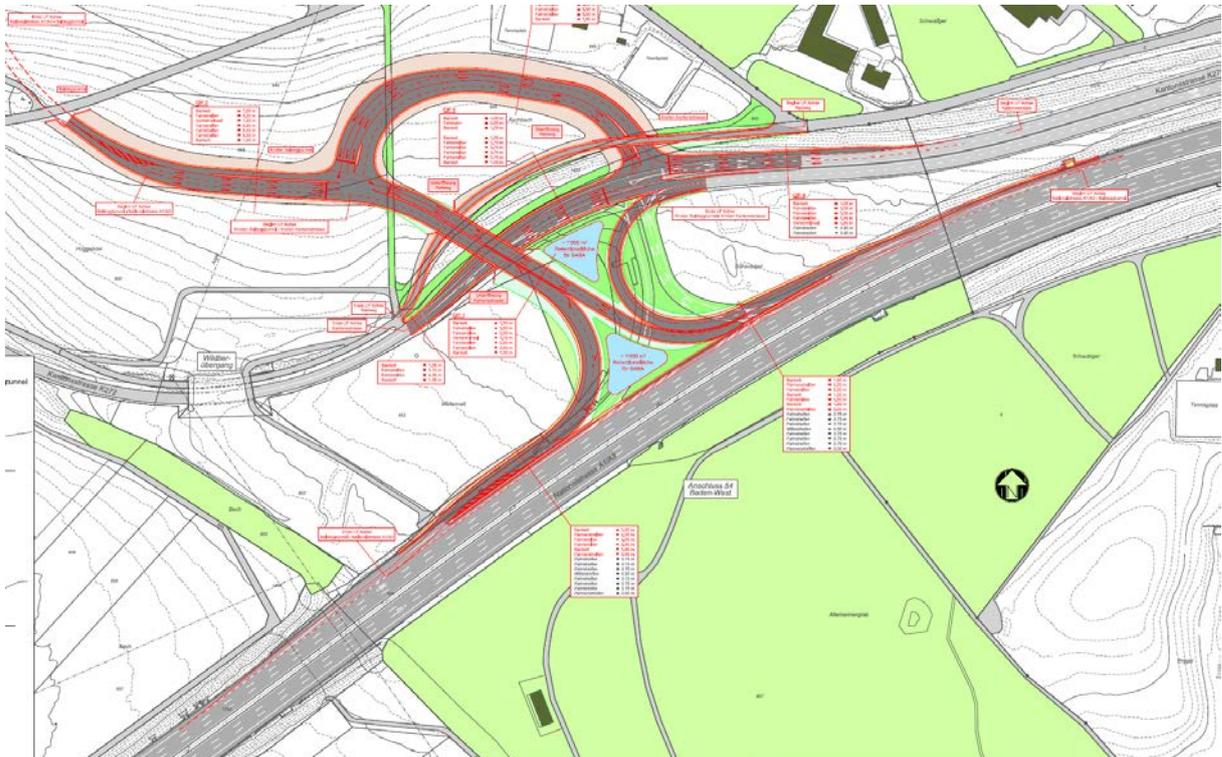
Bestvariante Anschluss Baldeggtunnel (Quelle: SNZ; Situationsplan 30.11.2012)
